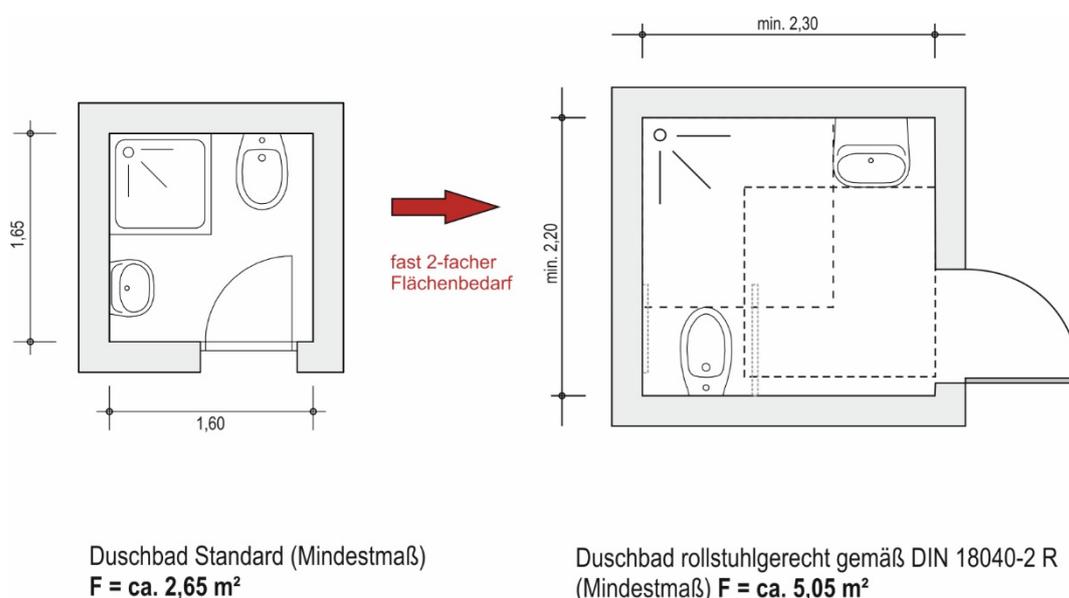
Flächenvergleich Mehrflächen Standard-Bad zu rollstuhlgerechtem Bad
